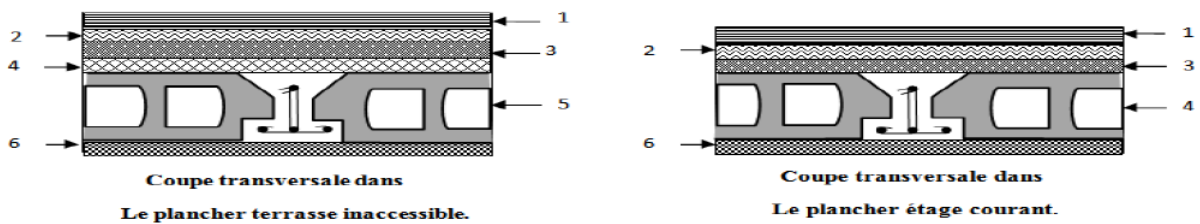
coupe transversale sur les plancher en corps creux
